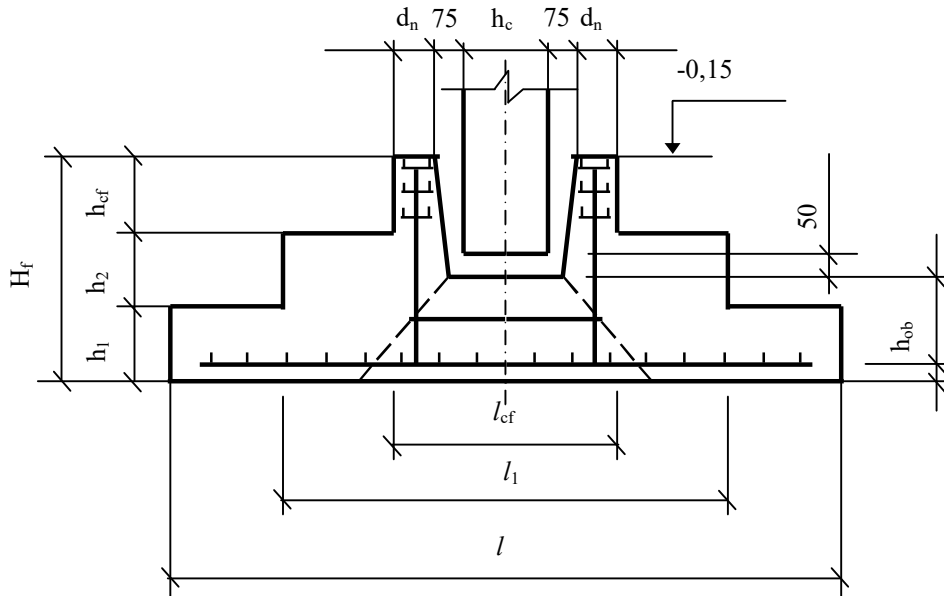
Конструкція фундаменту під збірну колону без підколонника
